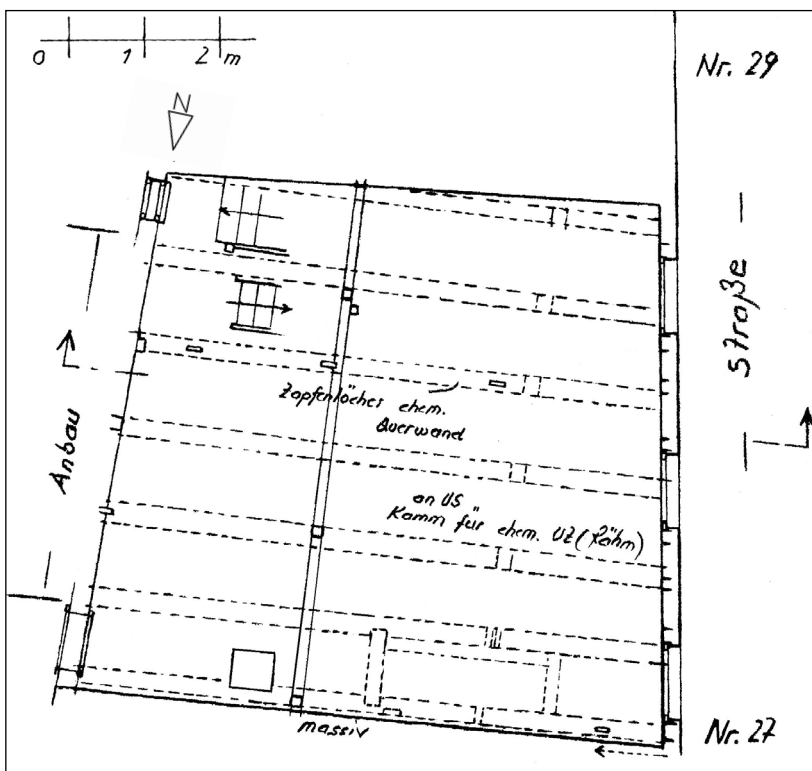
Im Grün 27, Grundriss 2. Obergeschoss.
